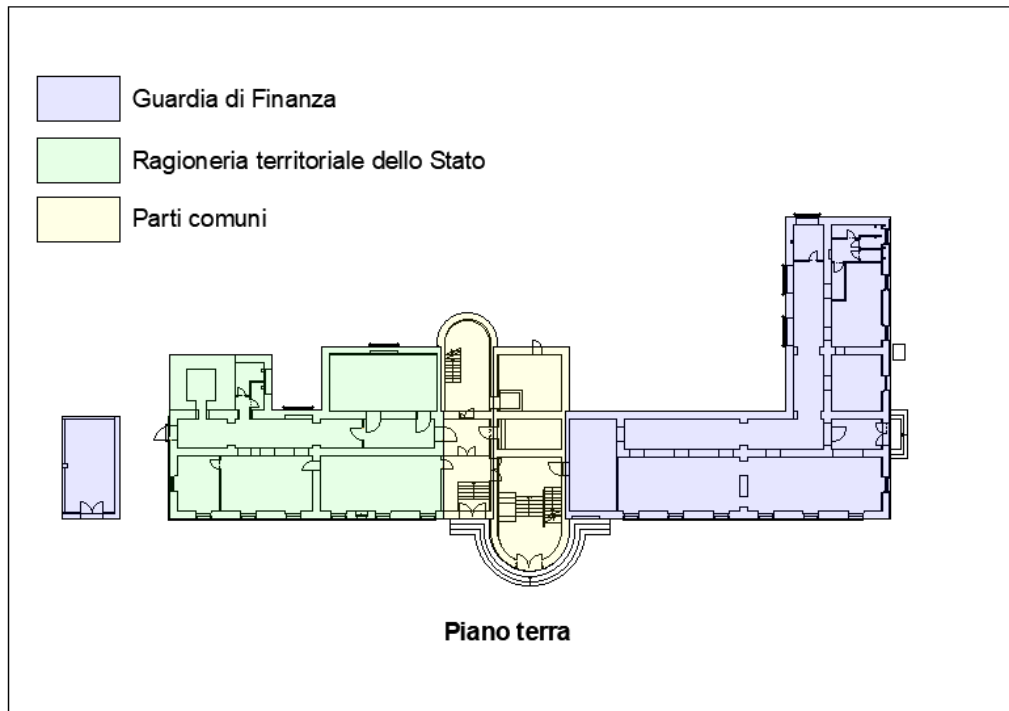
Pianta piano terra: piano di razionalizzazione e future Amministrazioni utilizzatrici
